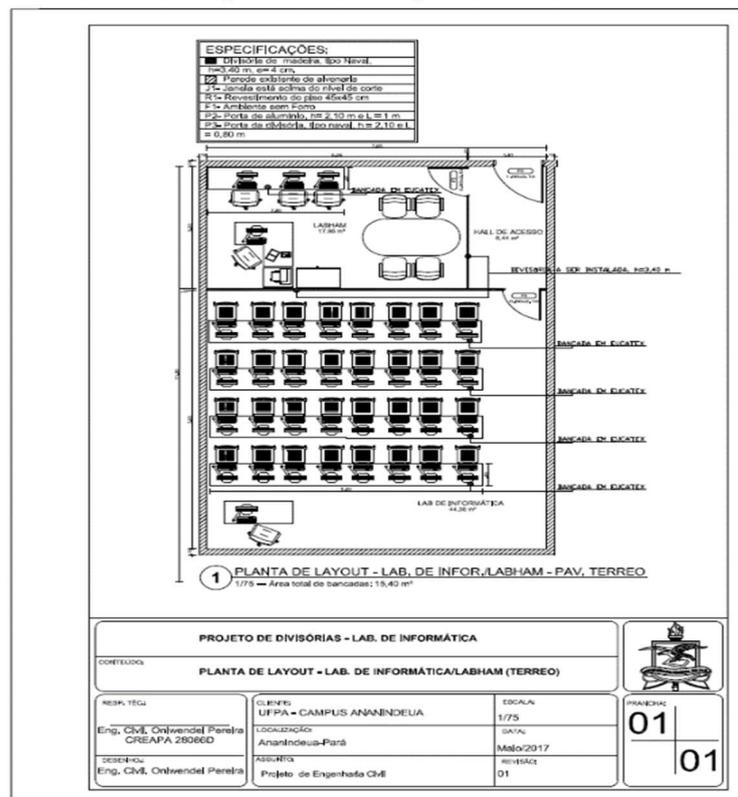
Planta baixa de implantação do LABHAM e do Laboratório de Informática, no bloco principal.
